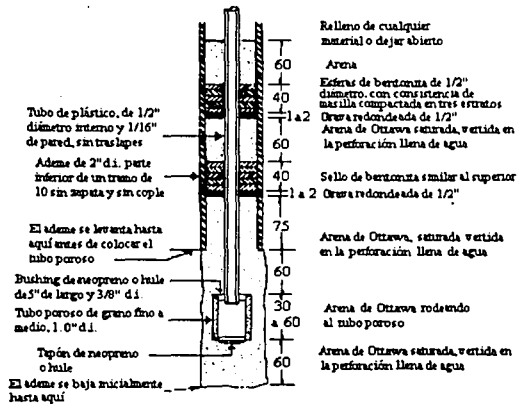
Piezómetro abierto Tipo Casagrande.
